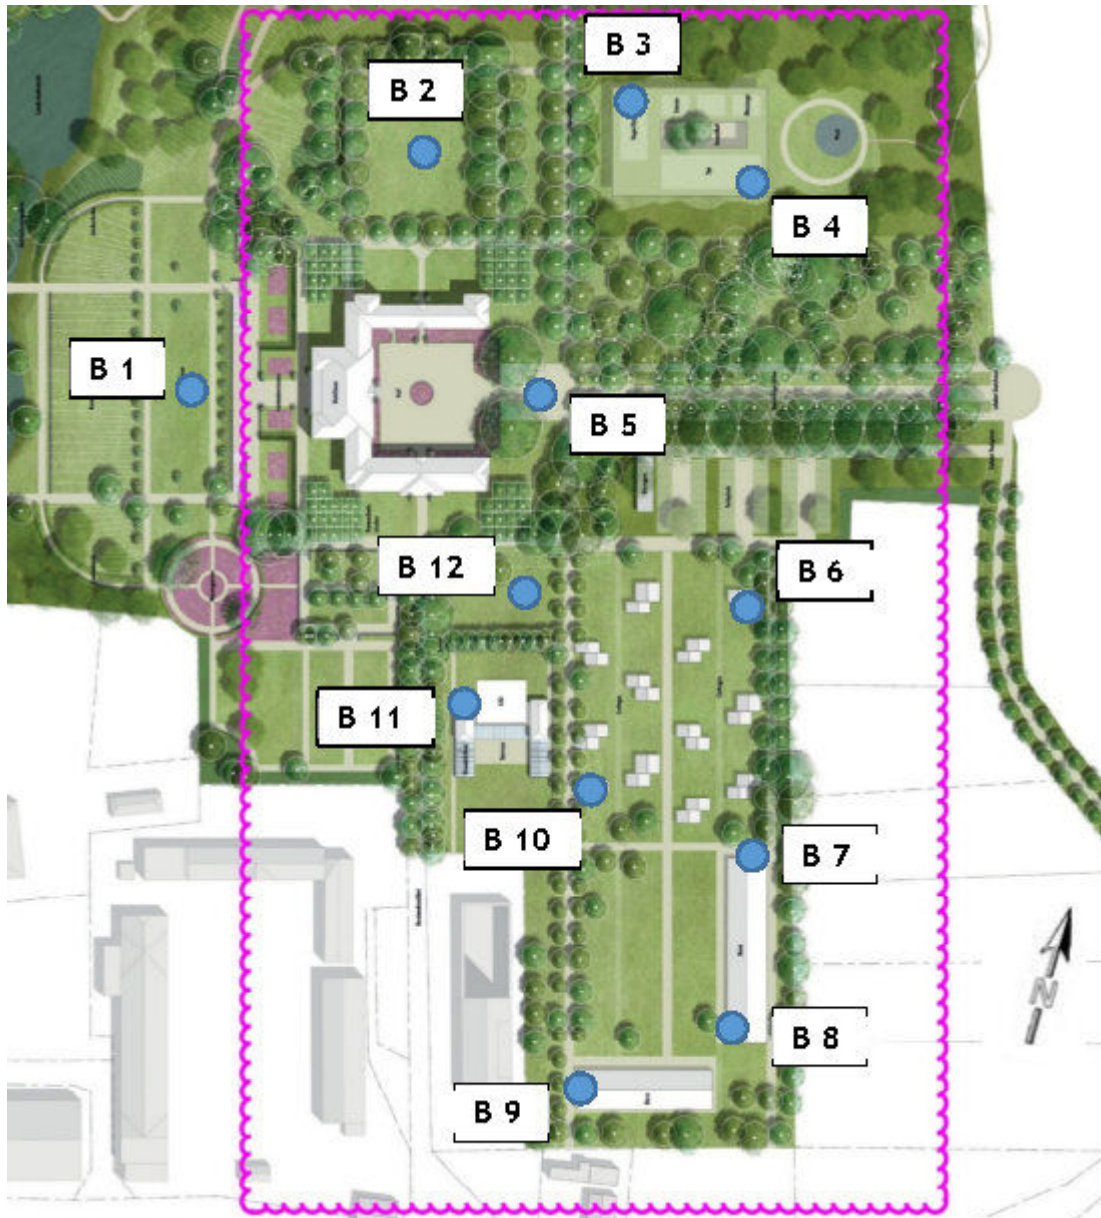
Lageplan der Erkundungsstandorte, ELH Ingenieure, 29.01.2026
